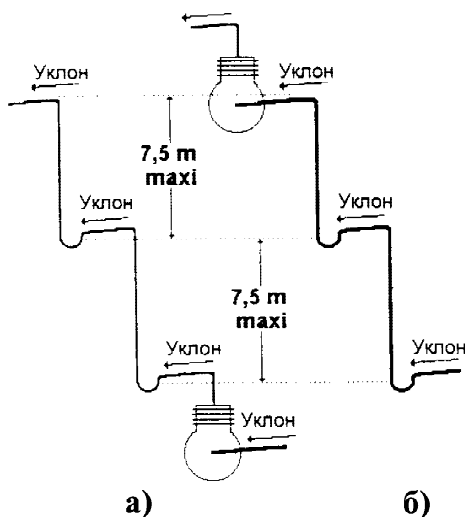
Схема установки маслоподъемных петель на восходящих участках трубопроводов длиной более 7,5 метров: а) нагнетательный трубопровод, уклон не менее 12 мм на 1 м, б) всасывающий трубопровод, уклон не менее 12 мм на 1 м.
